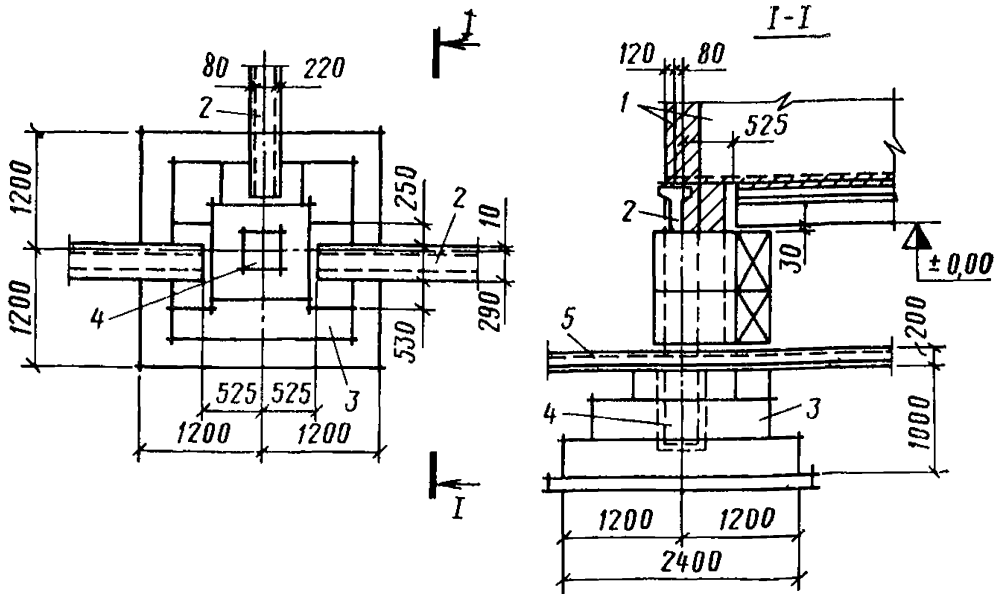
Схема устройства внутренних перегородок по фундаментным балкам
